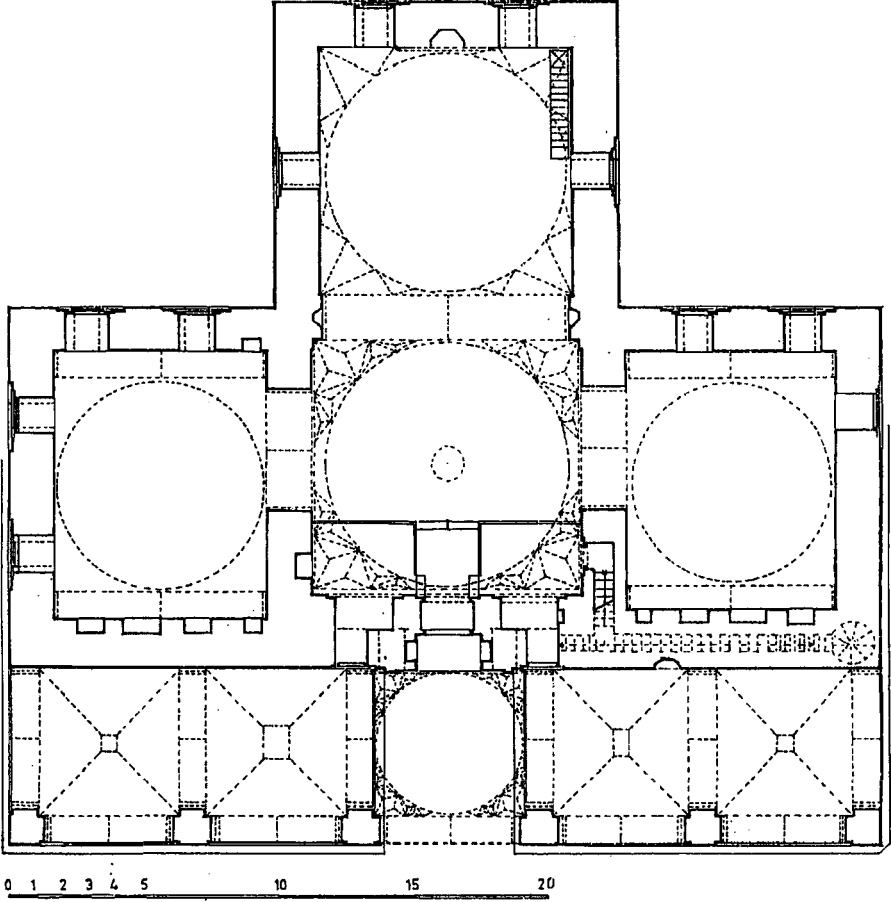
Bursa Yıldırım Camii plan ve cephesi (S.Çetintaş'dan)
